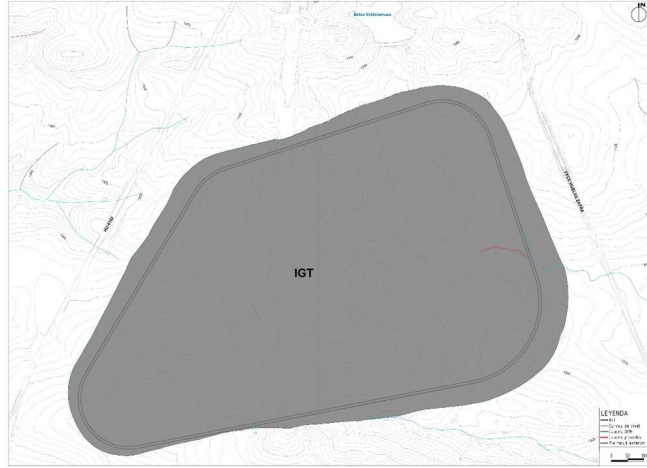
Cauces objeto de DPH según la Junta de Andalucía, con la planta de la IGT
